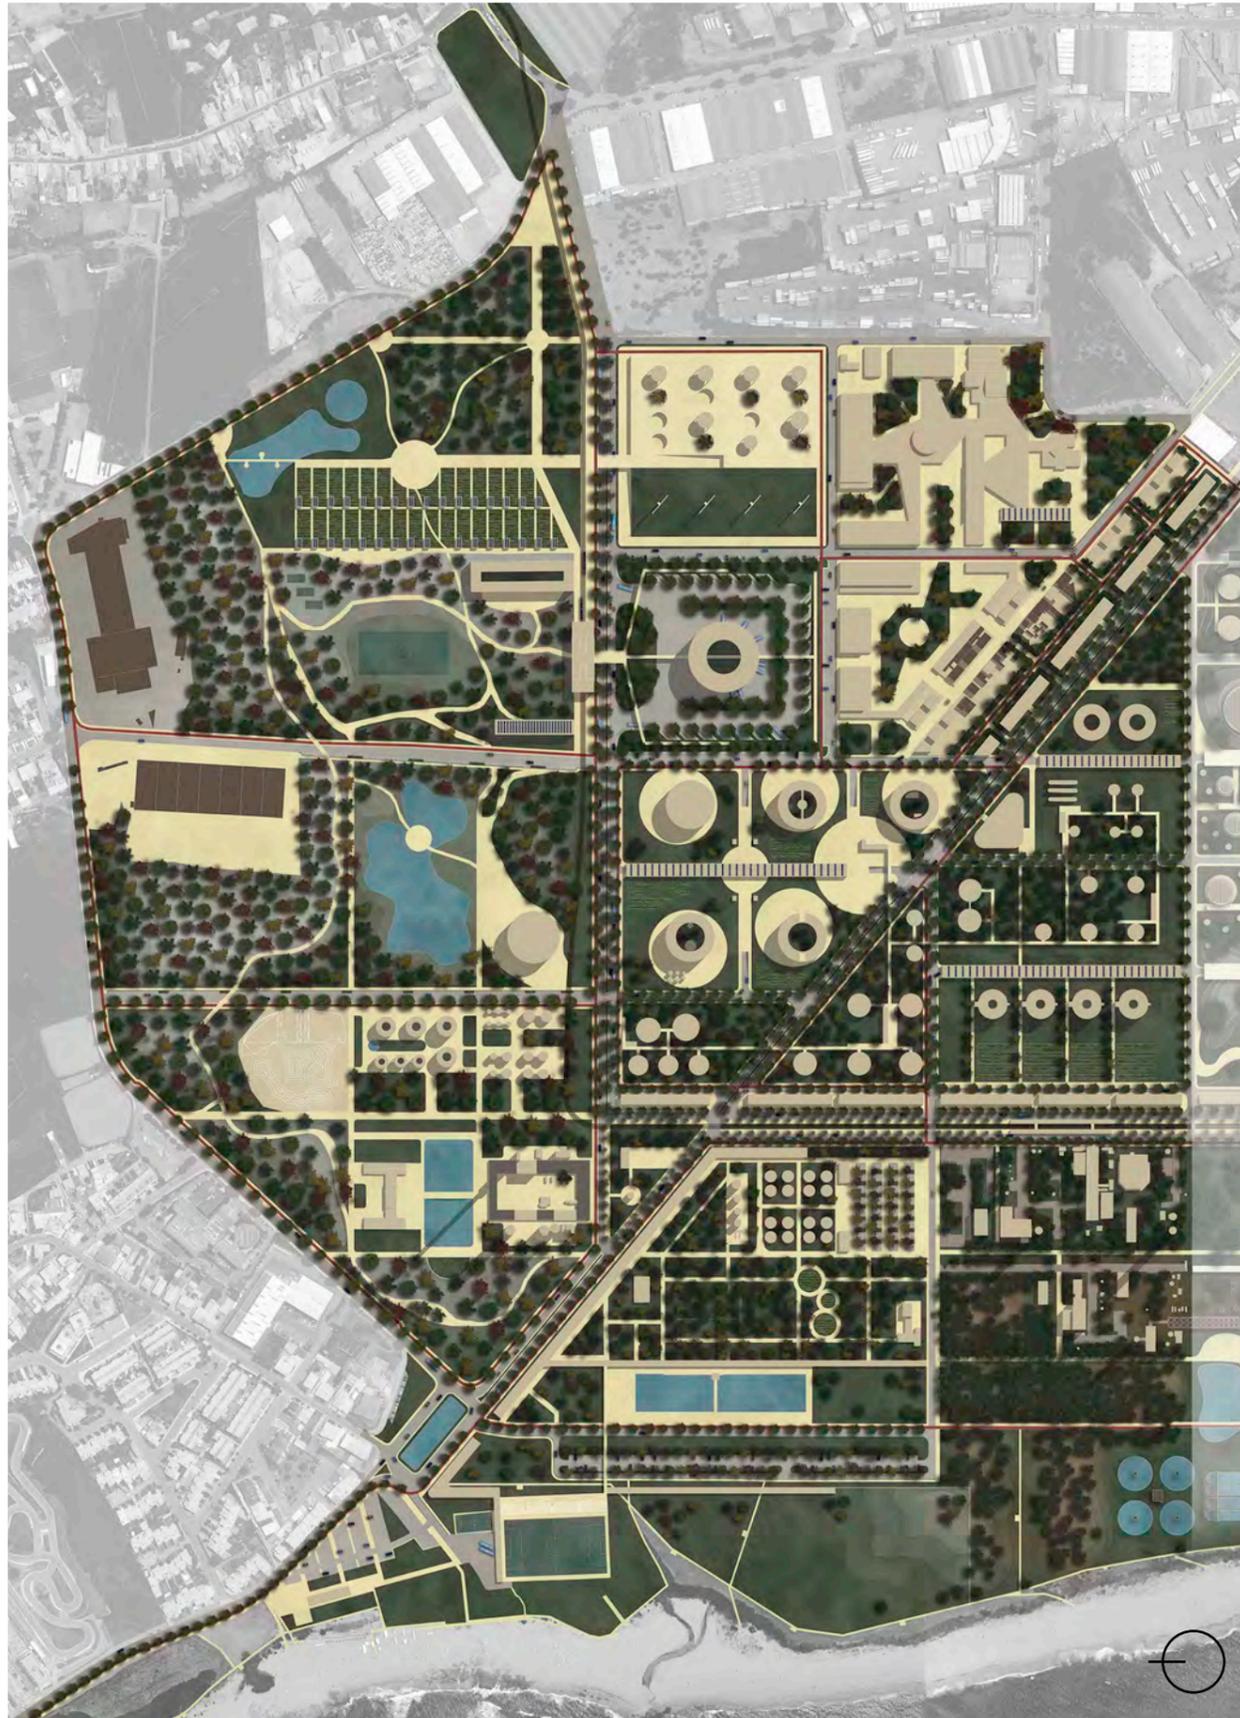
Planta da Proposta do Grupo A à escala 1:7000
